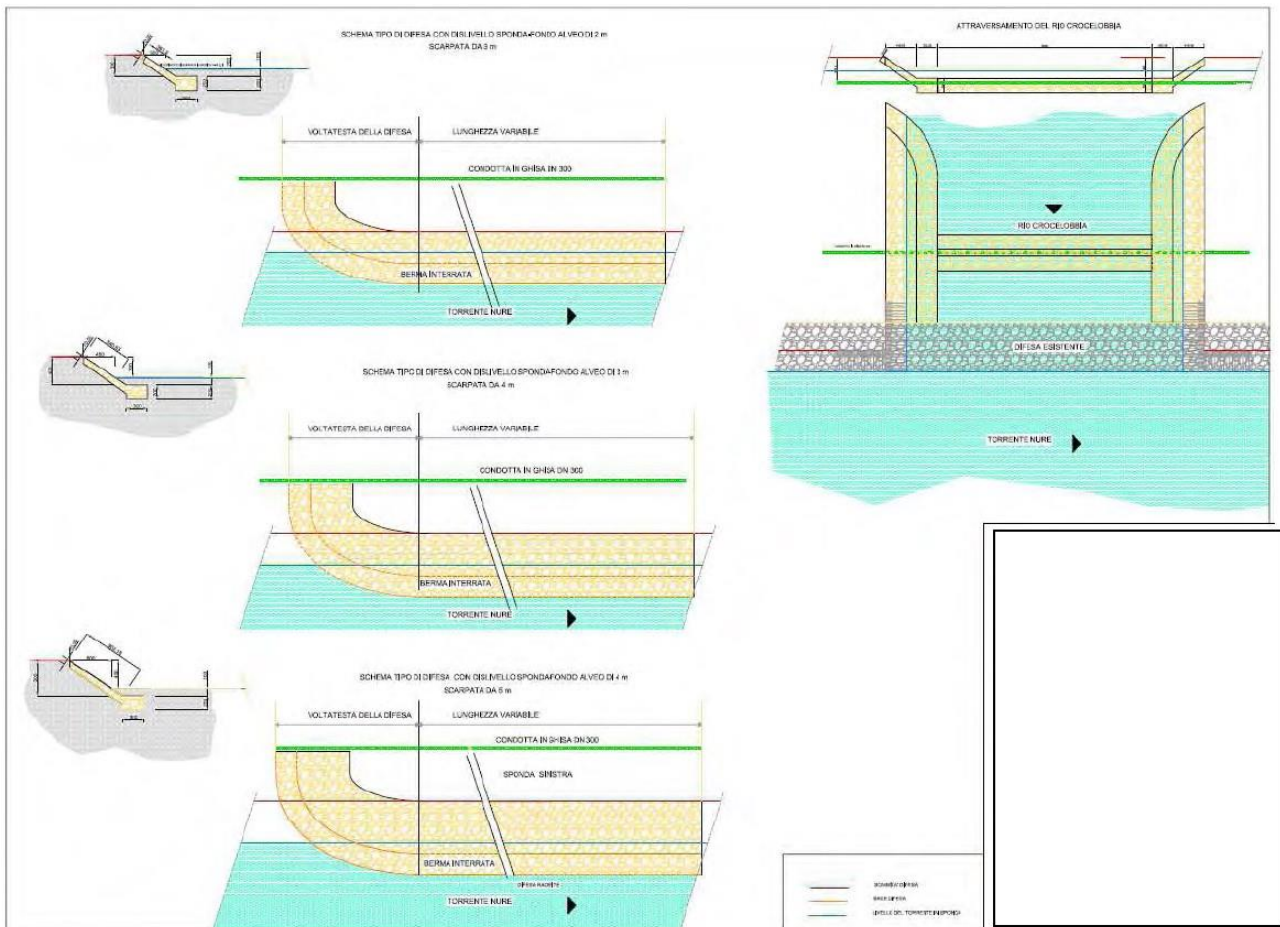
Dettaglio delle opere di difesa spondale in progetto
